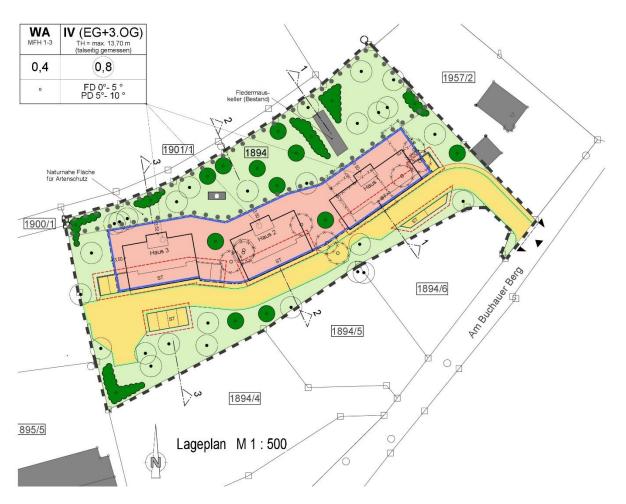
KUPFERGRAU Architekten GmbH Planausschnitt Anlage A Bebauungsplan
